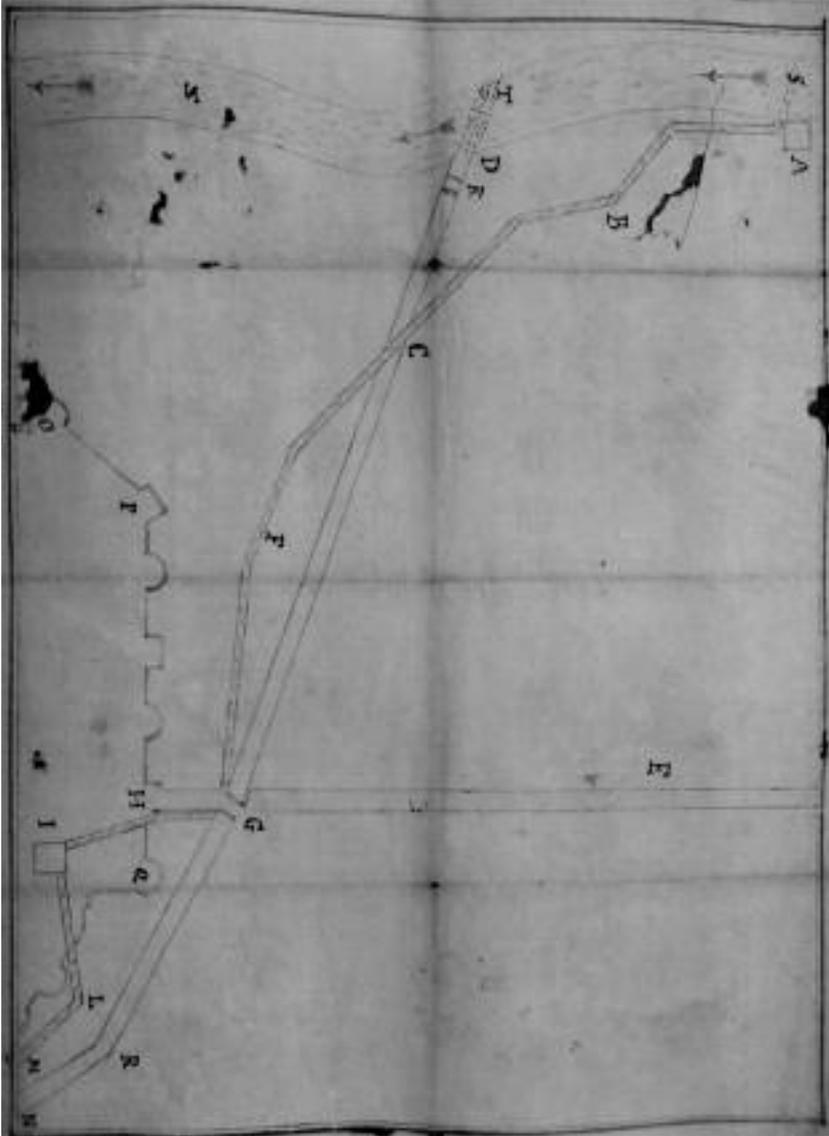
SASE. Sezione VIII - Amministrazione del Porto, 105. Pianta allegata al verbale delle modifiche al progetto iniziale richieste dal Gabus.
